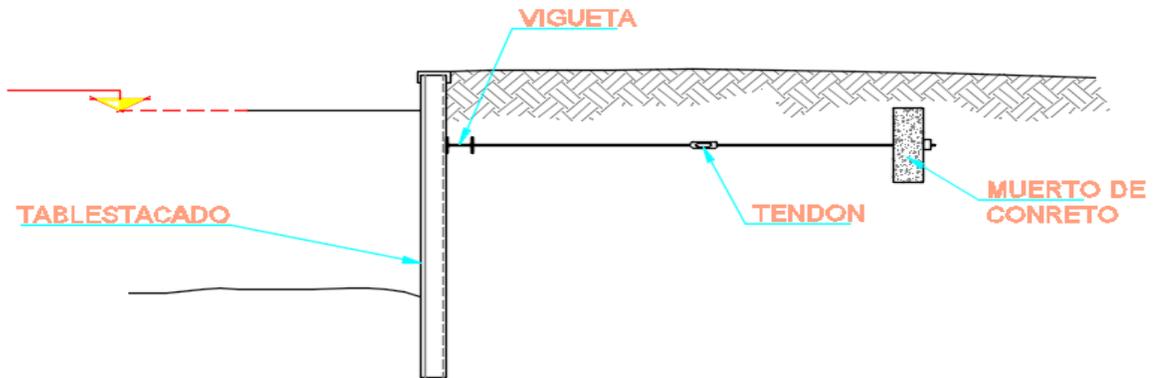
Tablaestacado anclado con muerto de concreto.
